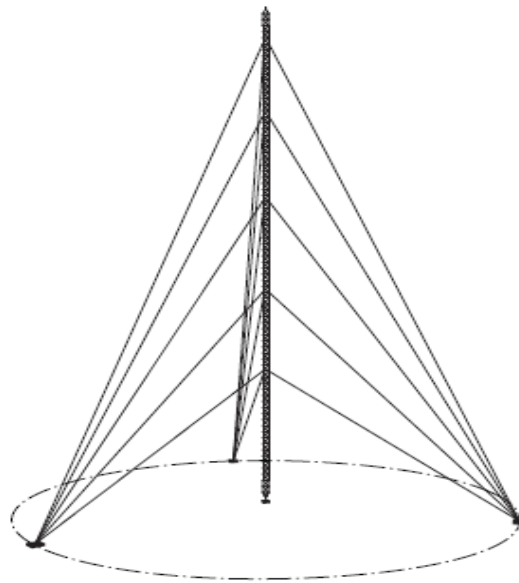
Torre arriostrada vista en elevación (disposición de los cables)
